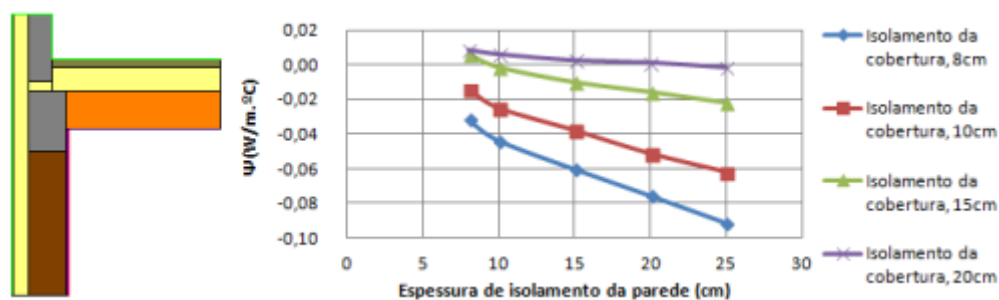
Variação do valor  $\Psi_e$  do pormenor construtivo da ligação de fachada (parede simples) com cobertura plana (sem platibanda)
